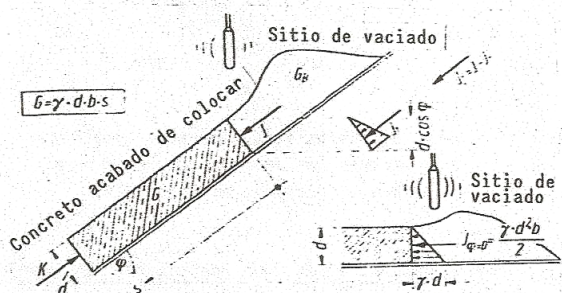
Empuje del concreto recién vaciado contra el concreto acabado de colocar.
